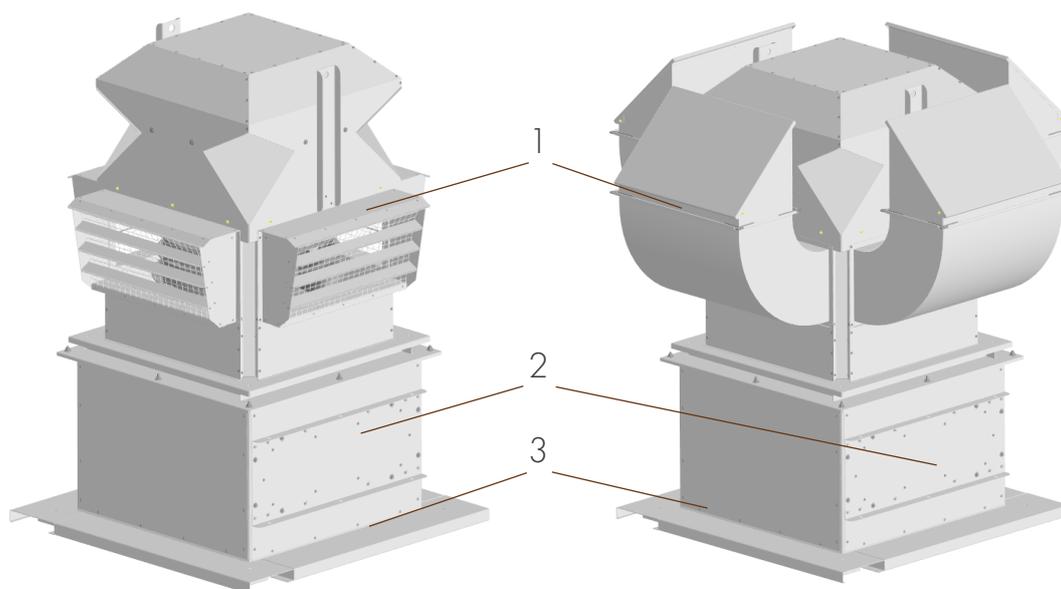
Установка крышного вентилятора на монтажный стакан
